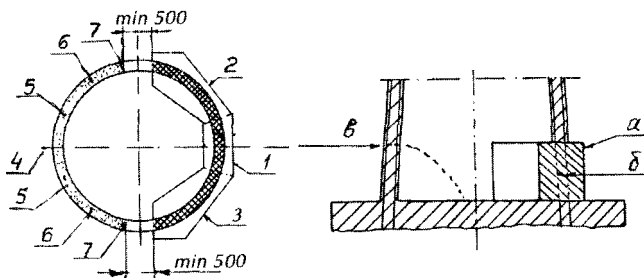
Устройство бетонной подушки и повалка железобетонной трубы:
